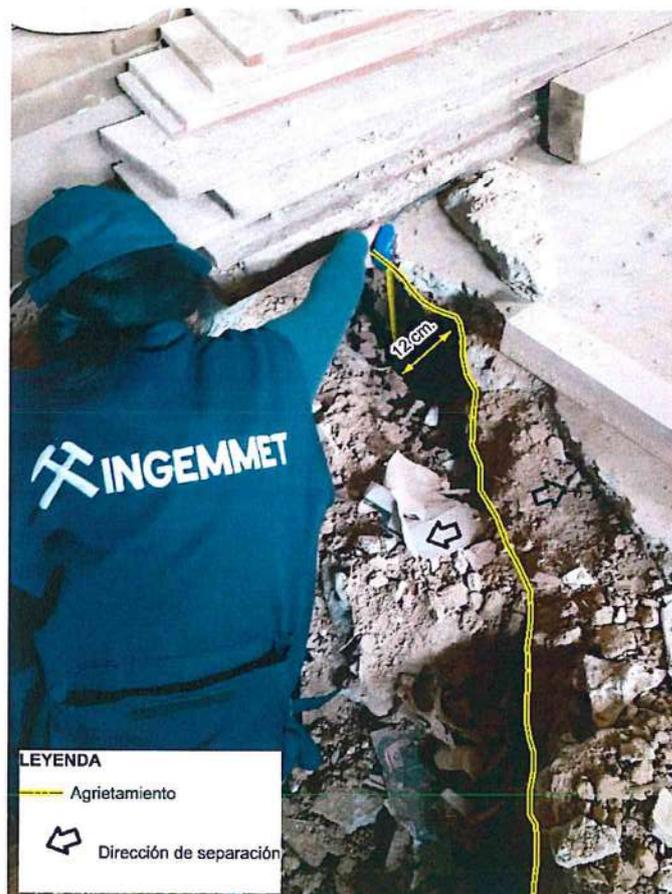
Piso de vivienda muy fracturado. Las grietas tienen una longitud de 90 cm y aperturas entre 10 – 20 cm.
